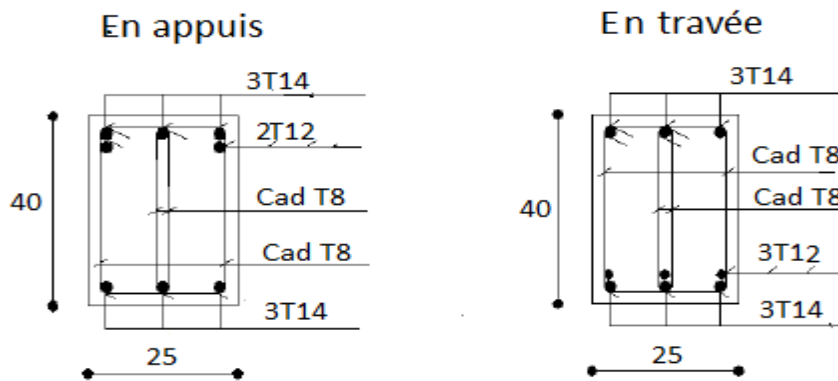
Schéma de ferrailage de la poutre secondaire.
